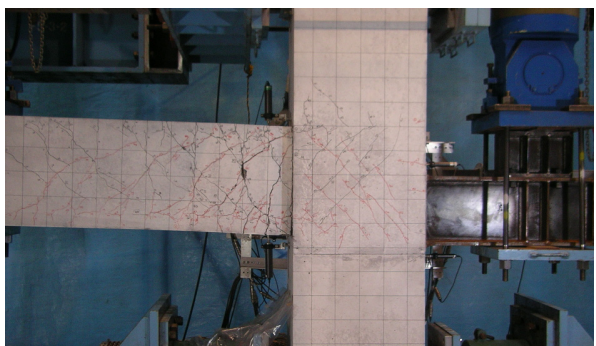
(b) No. 2 試験体破壊状況 ($Rrc=-1/33rad$.)
